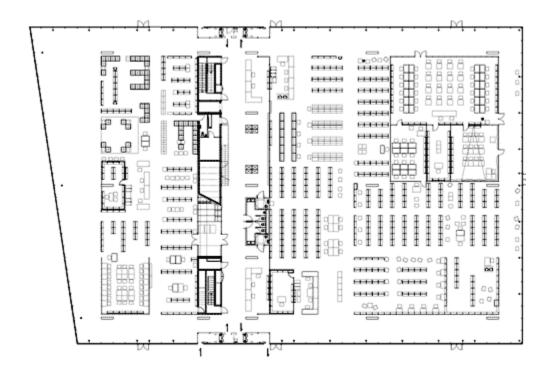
Planta arquitectónica, Mediateca de Venissieux.
